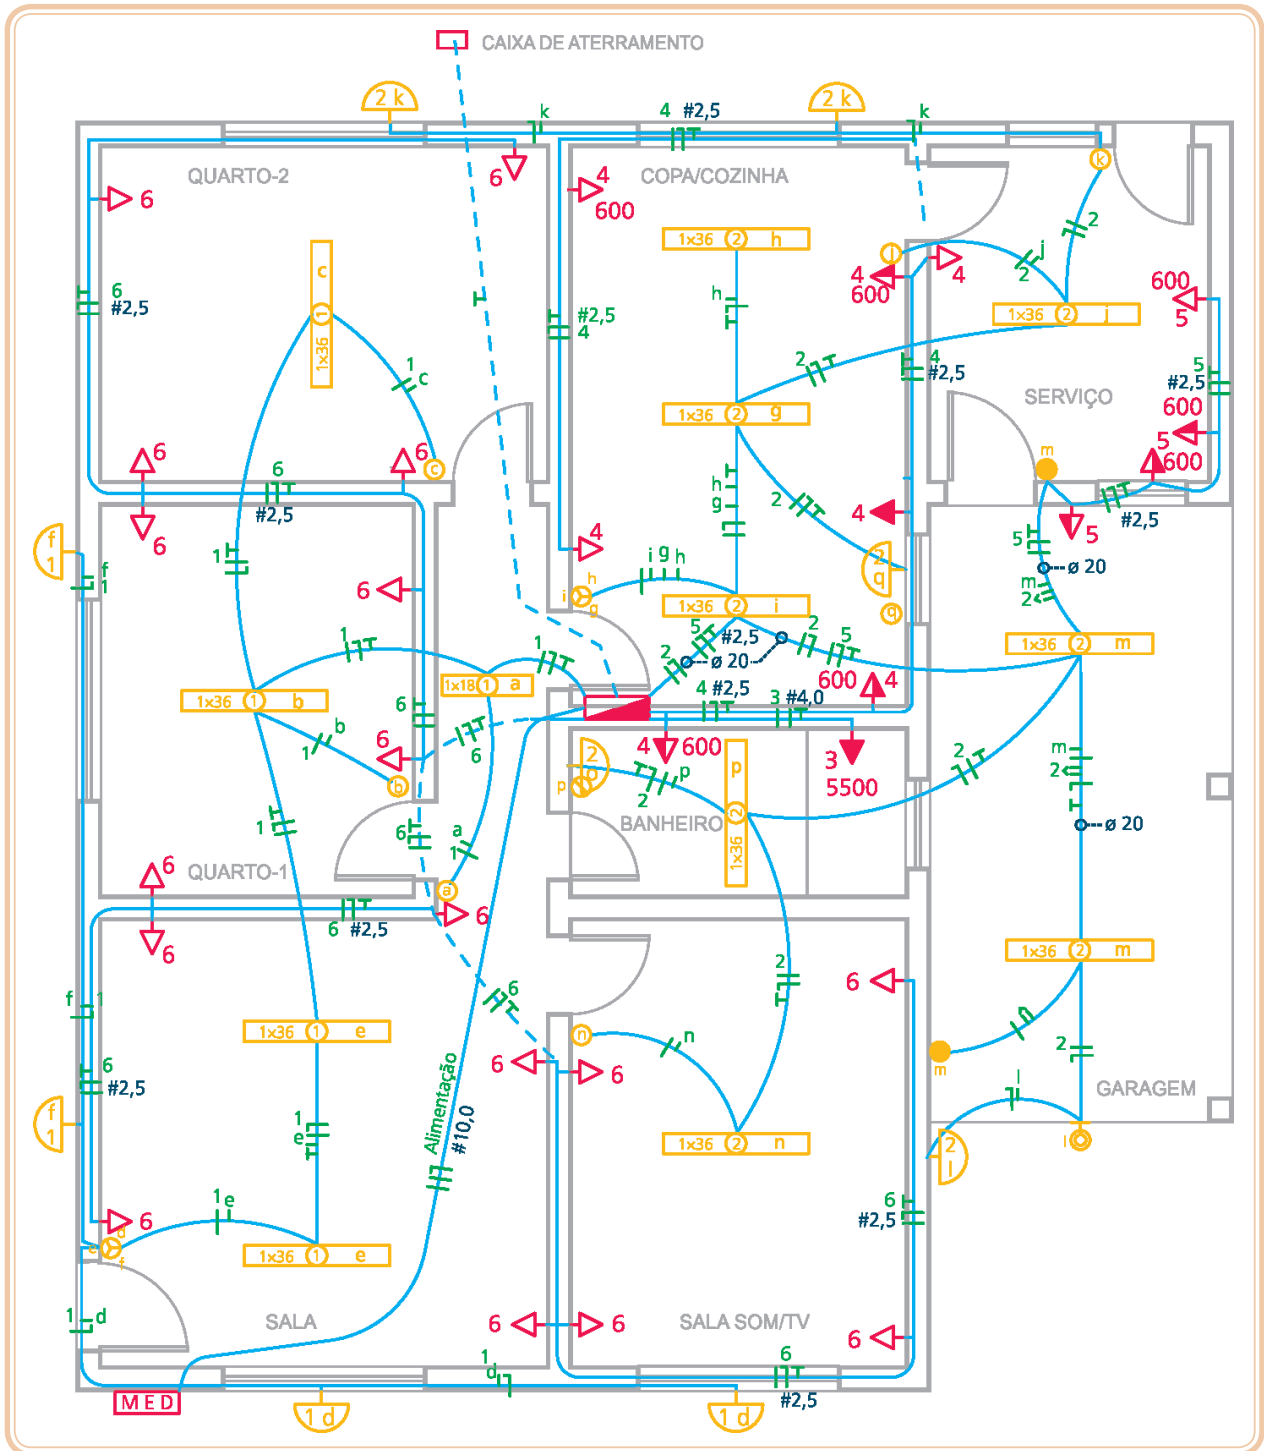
PE – 6 – planta completa com dimensionamentos
